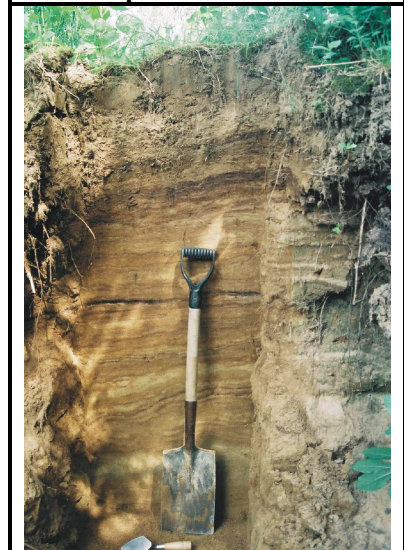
sondage dans une zone mal drainée – projet 20-3671-8927.
